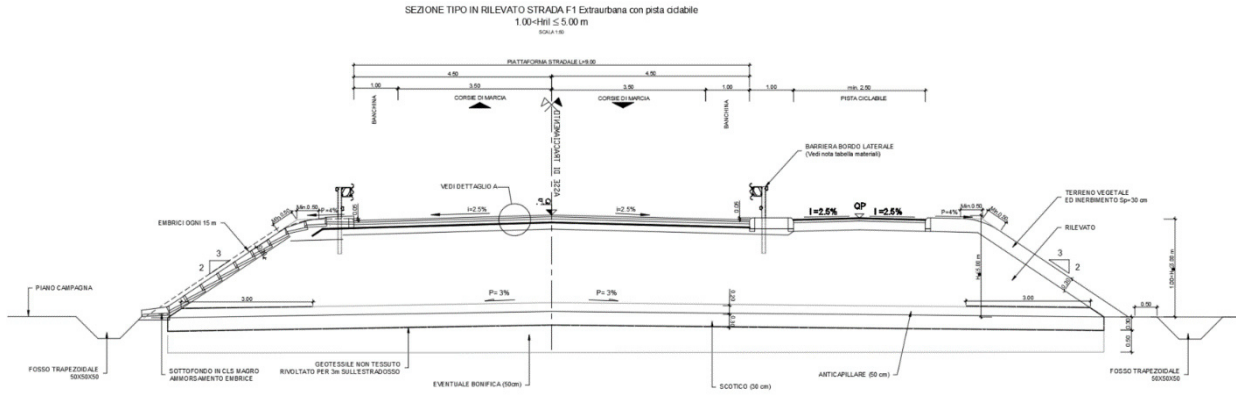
Sezione tipo di progetto in rilevato con barriera
